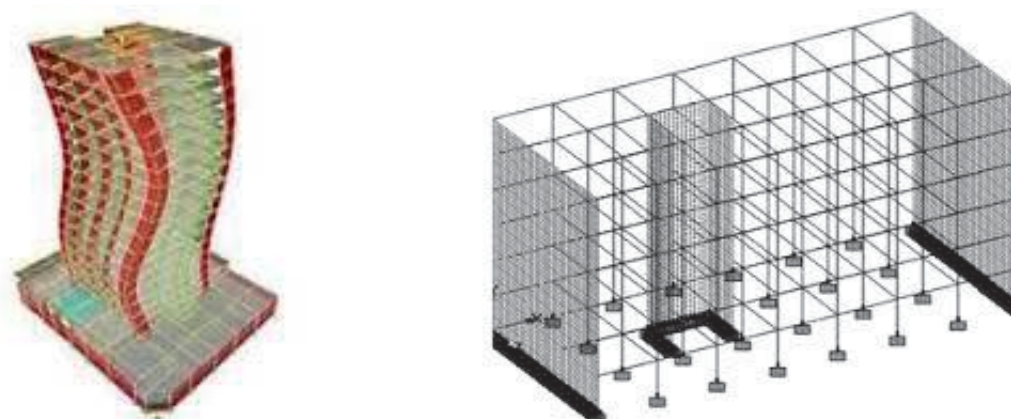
Sistema estructural de vigas, porticos y placas de concreto armado.
